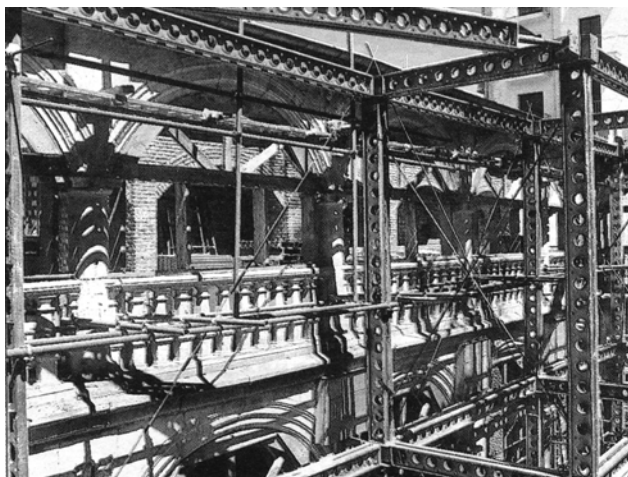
Palacio de San Boal: trabajos de restauración del claustro.
